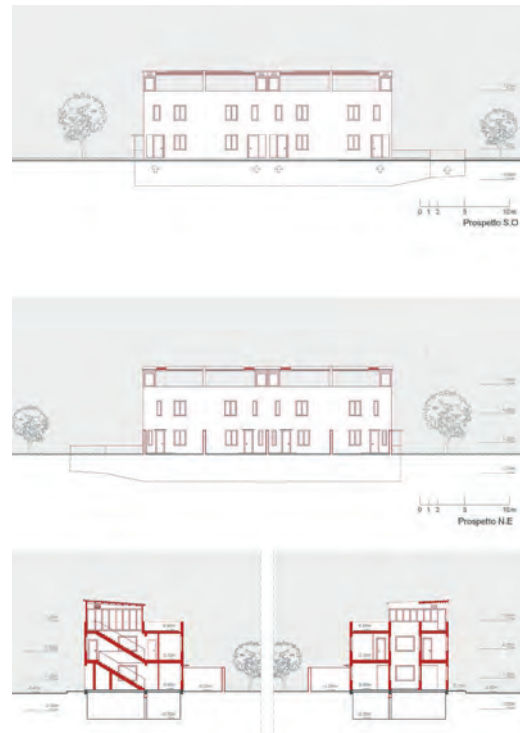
| Prospetti e sezioni di progetto (edificio C)
